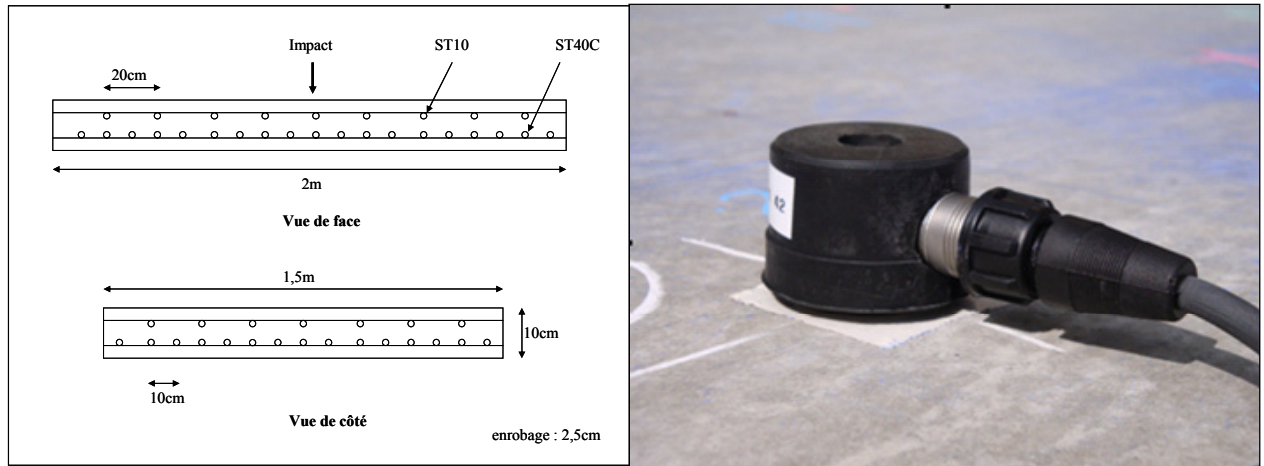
coupe de la dalle et accéléromètre collé sur la dalle
